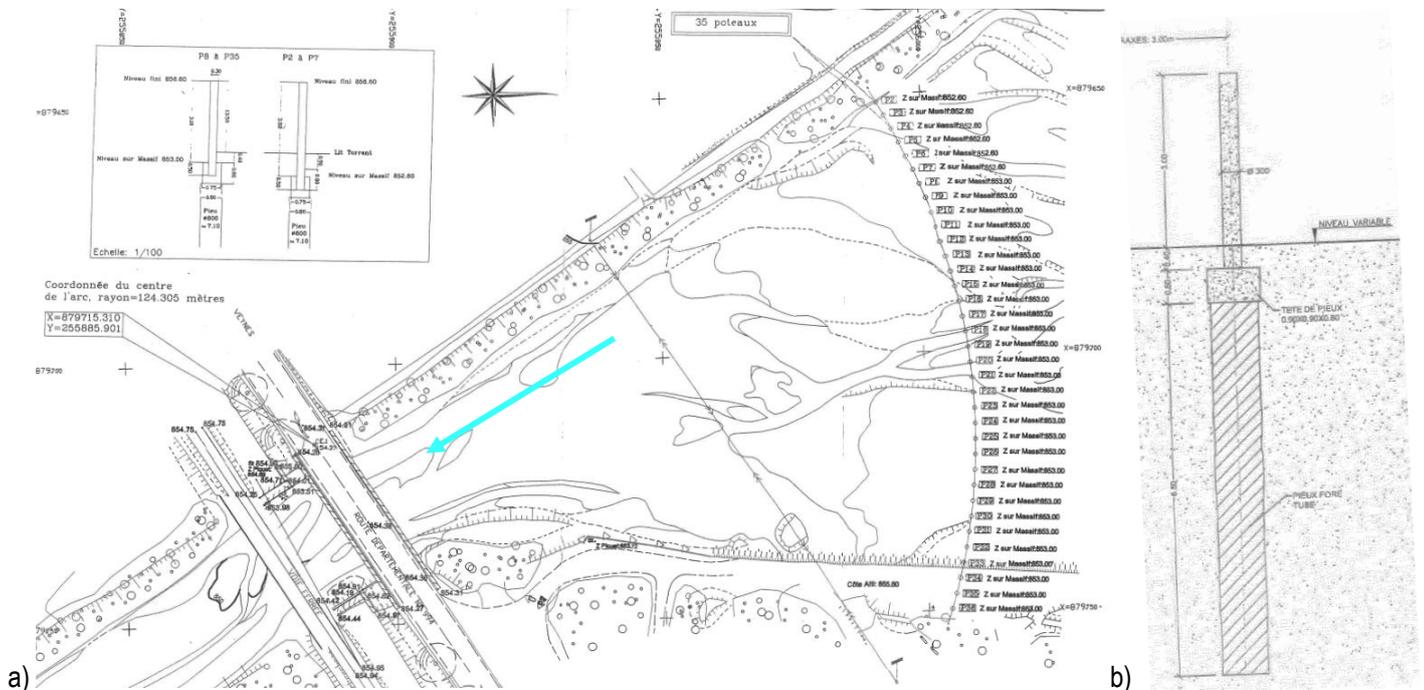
Plans de l'aménagement : a) Plan de masse du piège à flottants en amont de la RD994 et b) coupe type d'un pieux (source : Groupement Gardiol TP – Franki Fondation, 2006)
